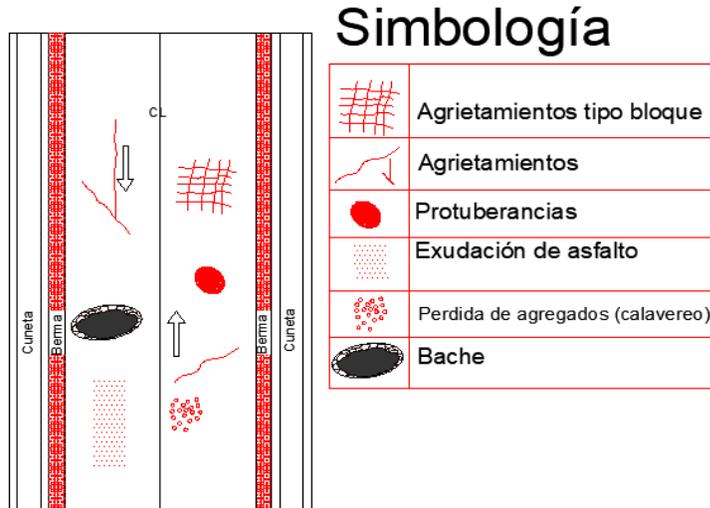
Diagrama de deterioros en pavimento flexibles
